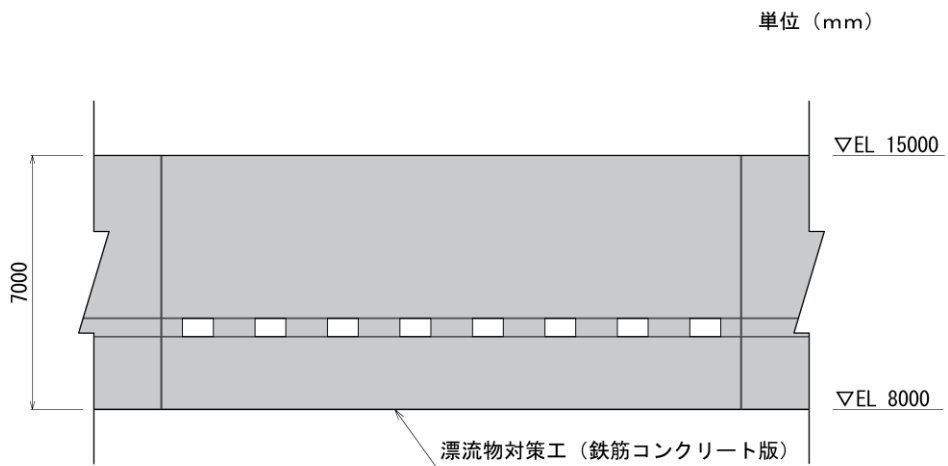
(2) 漂流物対策工 (鉄筋コンクリート版) の構造概要図 (正面図)
